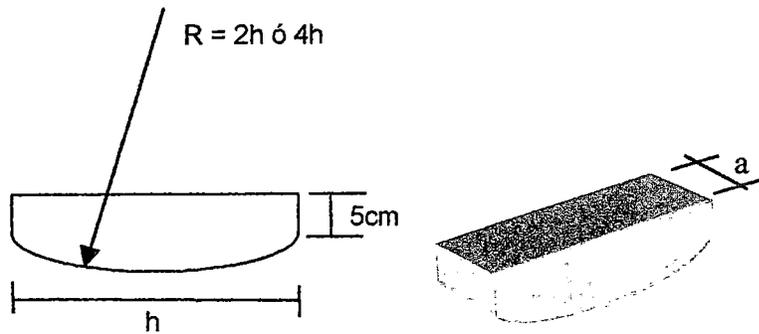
BLOQUES DE APLICACIÓN DE CARGA
